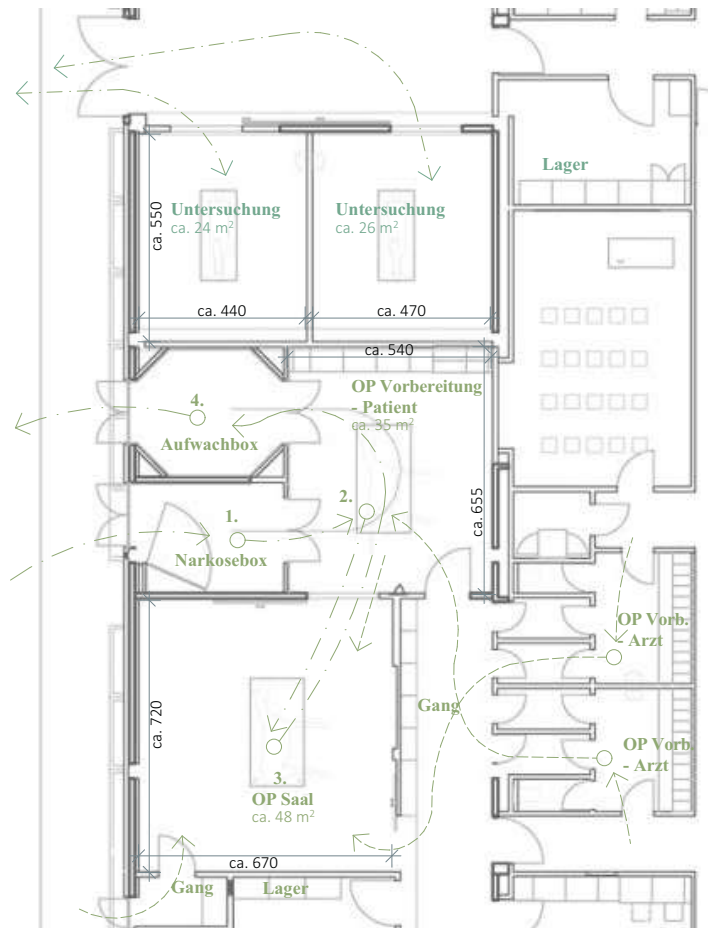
Grundrissausschnitt Erdgeschoß Freie Universität Berlin- Klinik für Pferde
